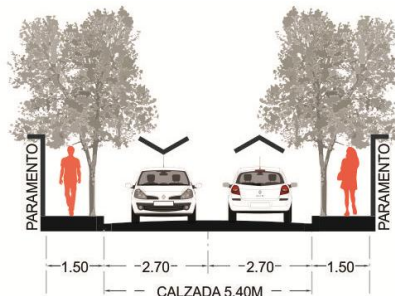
Sección Acceso a Colonia un carril de circulación por sentido.
